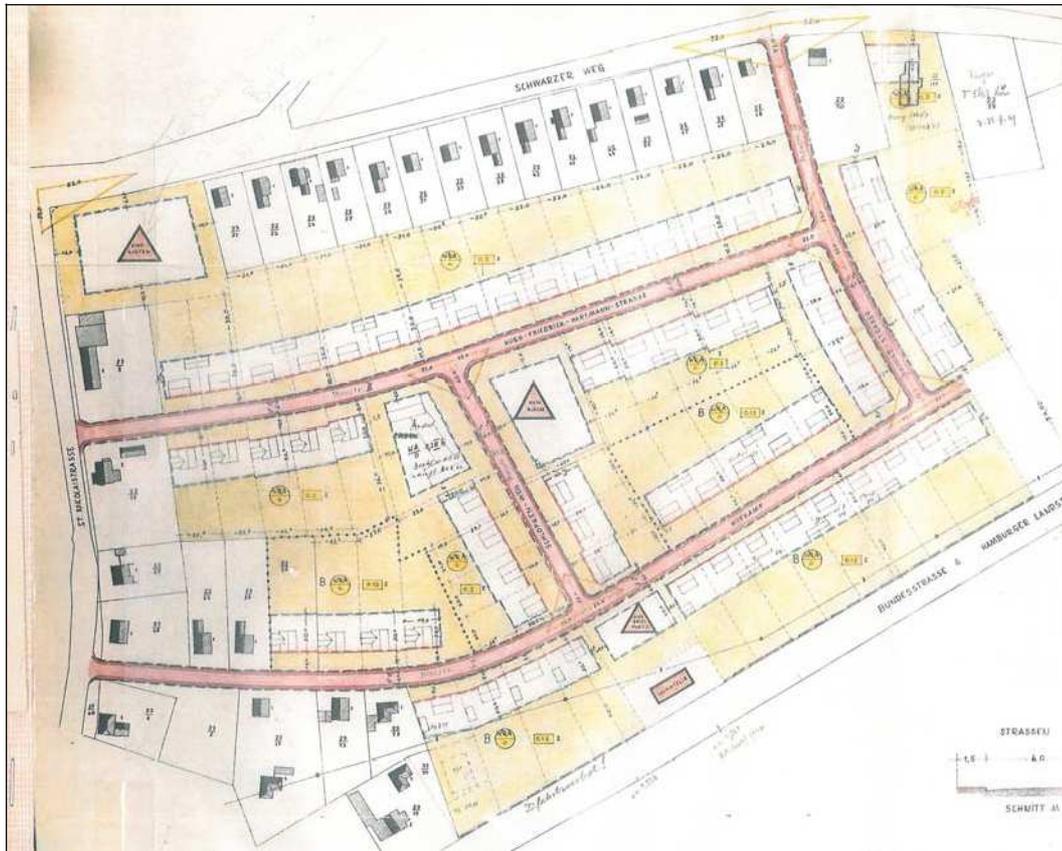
Bebauungsplan 1 "Hofkamp" aus dem Jahre 1960
